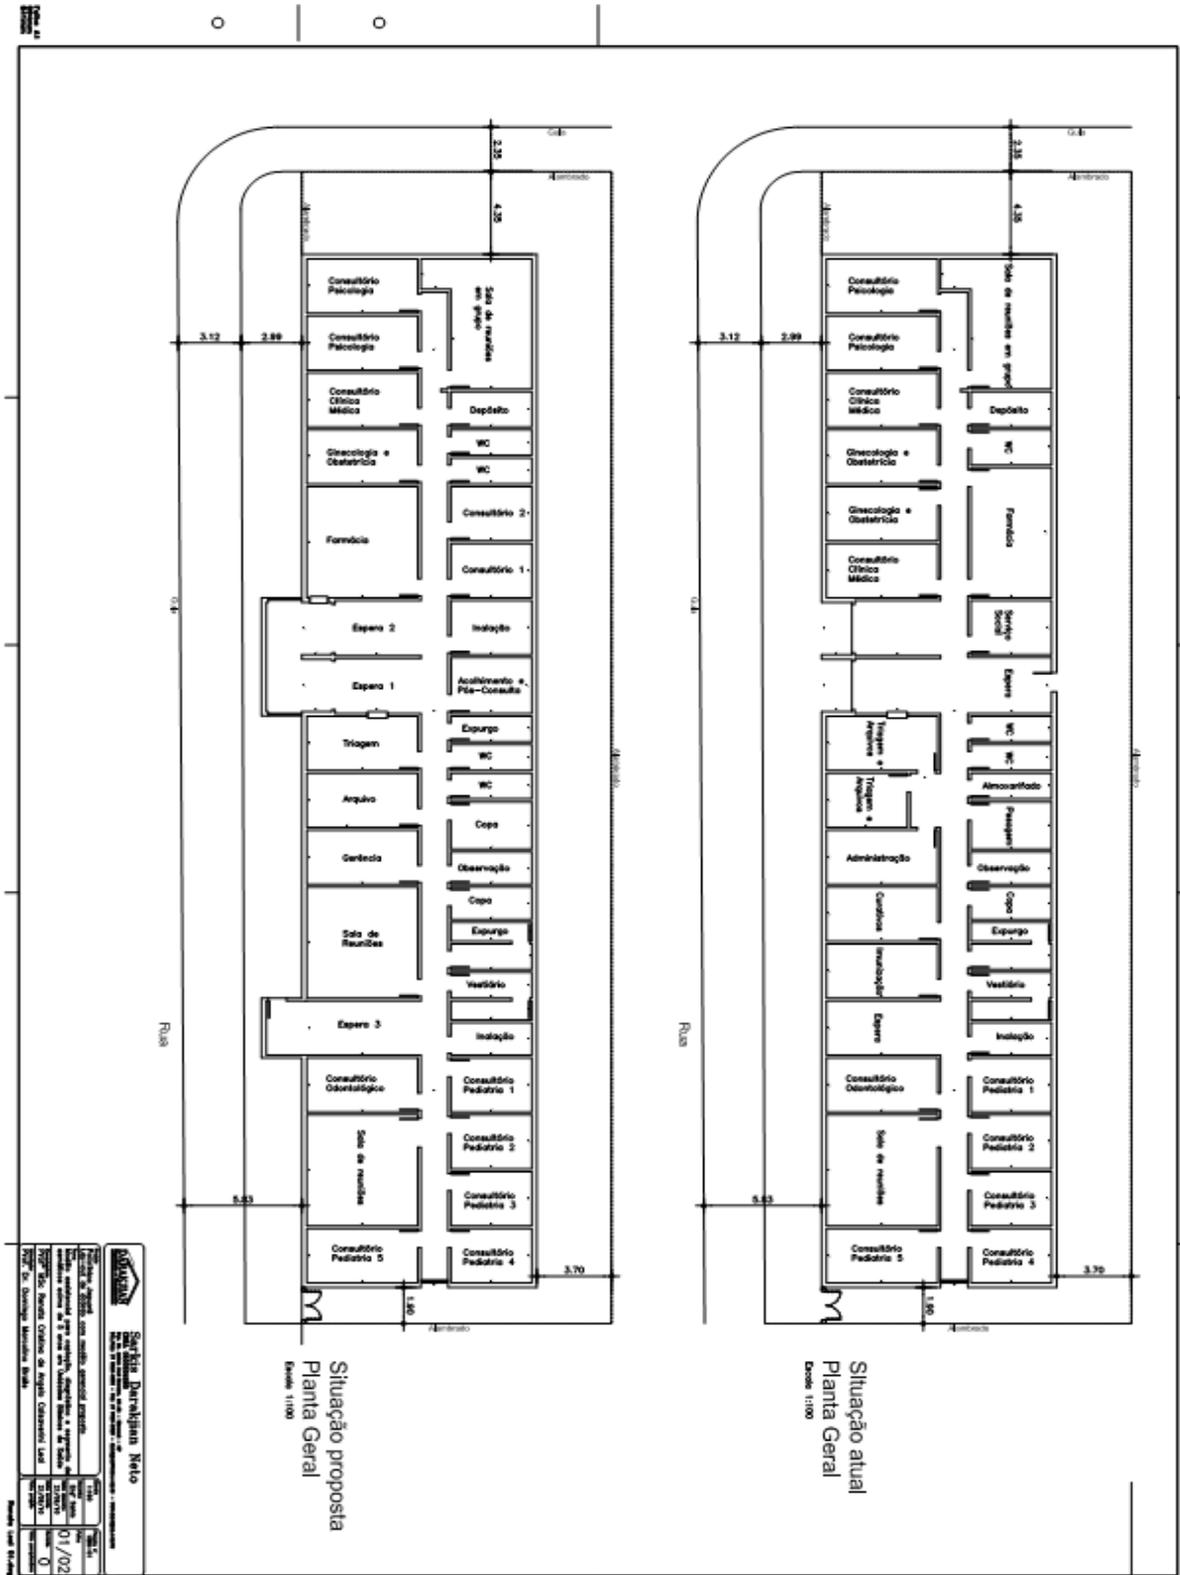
Situação proposta - Planta Geral / Situação atual- Planta Geral.
